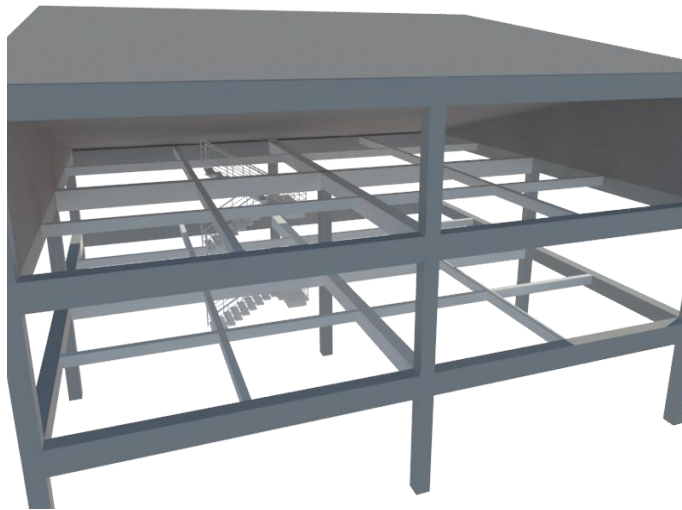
Tampak Timur dan Utara Balai Singgah
